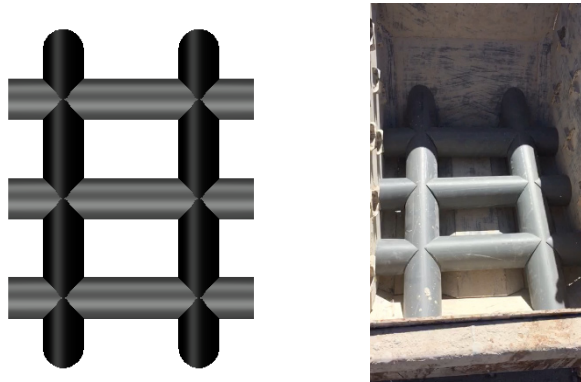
Disposición de las tuberías T, T2 y L1 en el molde.
